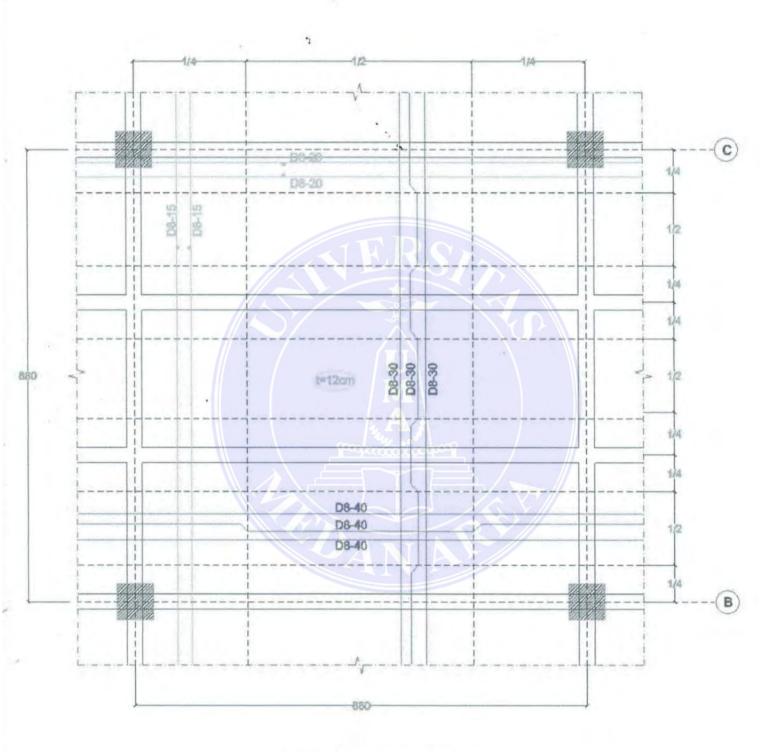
DETAIL PELAT LANTAI TYPICAL SKALA 1: 60
